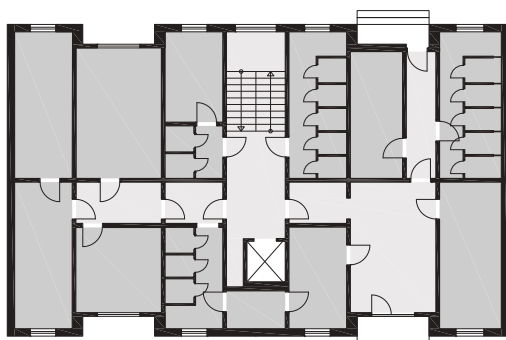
Konstrukční soustava B70 (Zdroj: panelaky.info)
